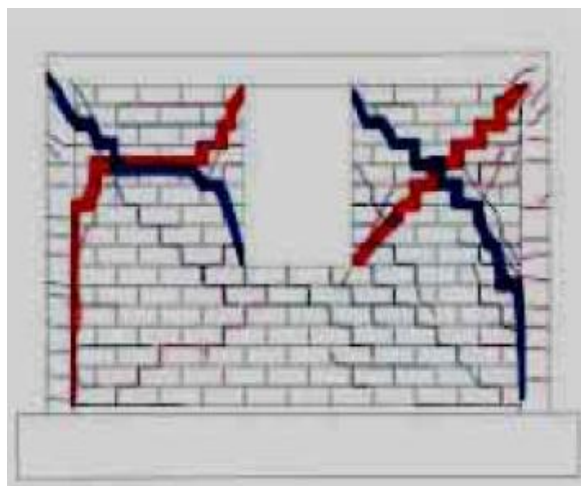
Grietas diagonales en los muros con aberturas
